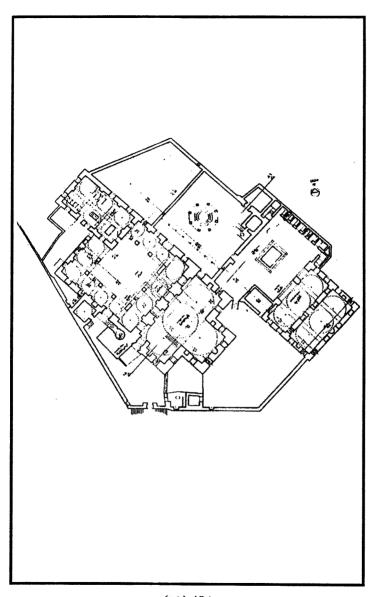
القصر الأحمر - مسقط أفقى للدور الأرضى عن محمود الألفى
